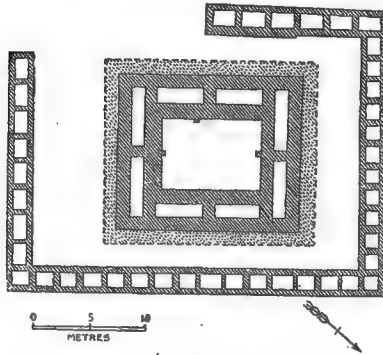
مسقط أفقي ورأسى للمقبرة ٣٥٠٣ في سقارة
